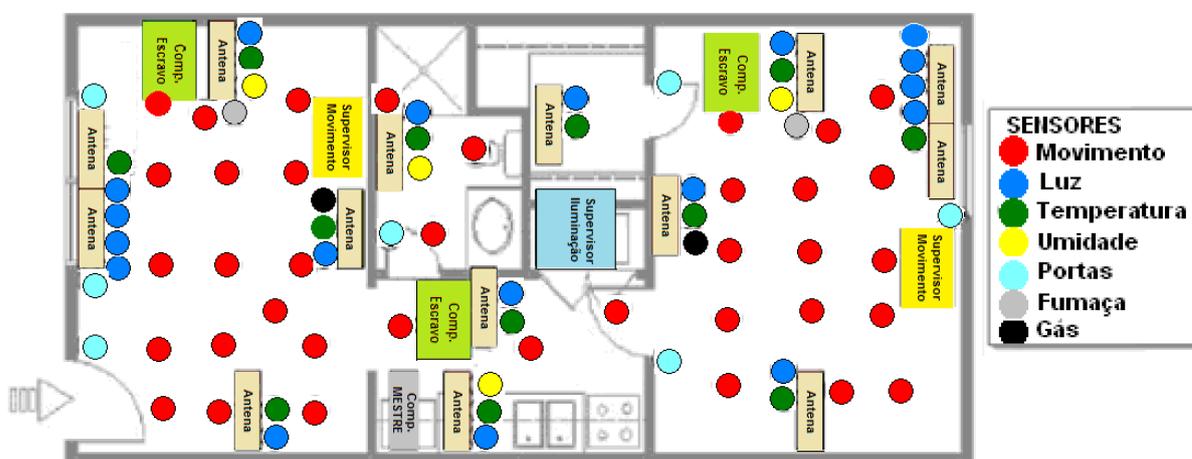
Planta baixa da Adaptive House com a localização dos sensores.
